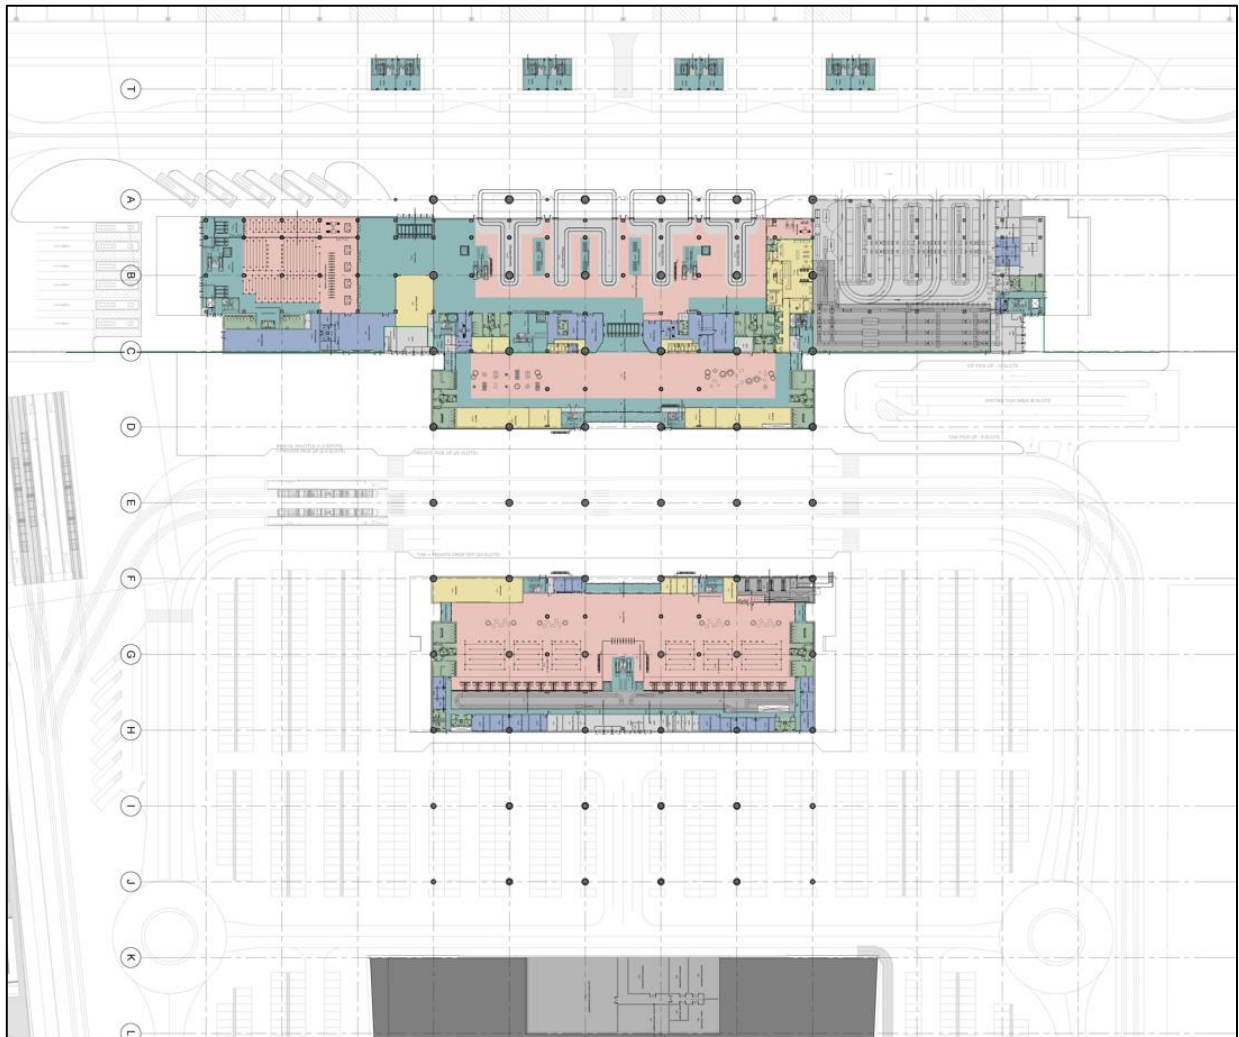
| Planimetria Piano Terra 2026– Zoning delle aree
